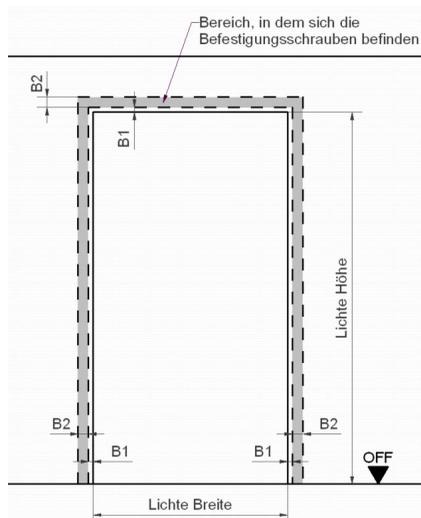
Maßskizze der Befestigungsbereiche für Schrauben (für Verschrauben an Montagewänden)
